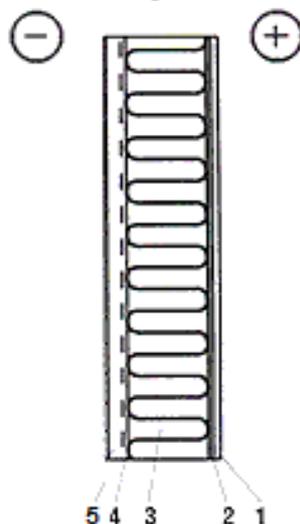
Каркасная система наружной стены: 1 - внутренняя обшивка; 2 - пароизоляция; 3 - утеплитель; 4 - ветрозащитный паропроницаемый материал; 5 - наружная обшивка.
